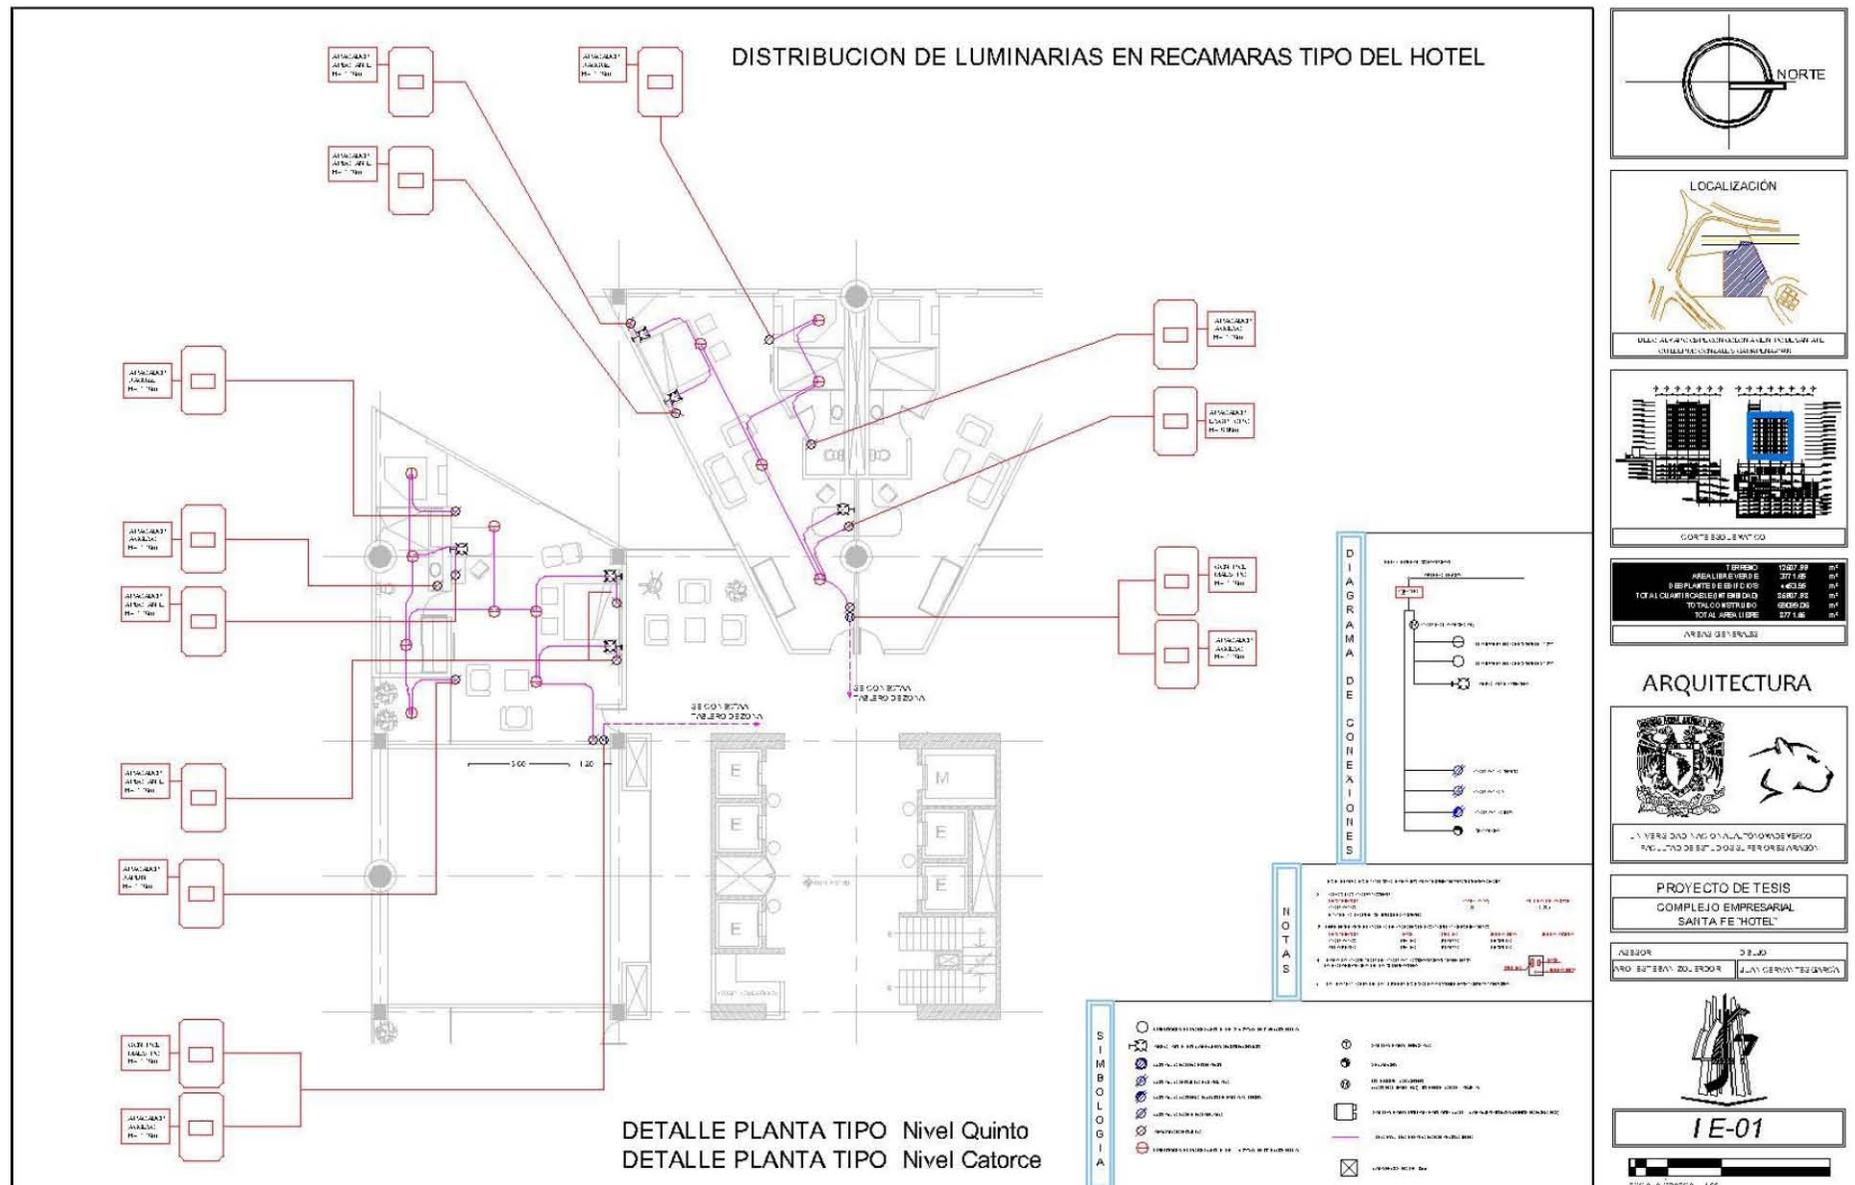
Plano IE-01; Plano distribución de luminarias en recamaras tipo de hotel. Edición propia.
